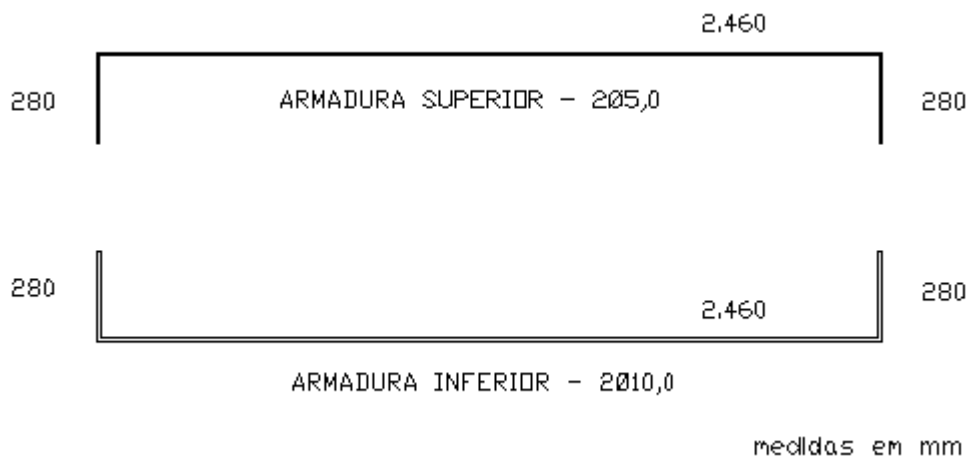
Armadura longitudinal das vigas VM1, VPF1, VPF4 e VPF7
